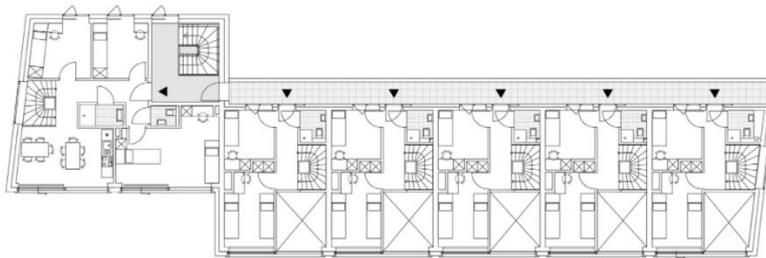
Planta do 3º piso do edifício Henry Korner Hall
